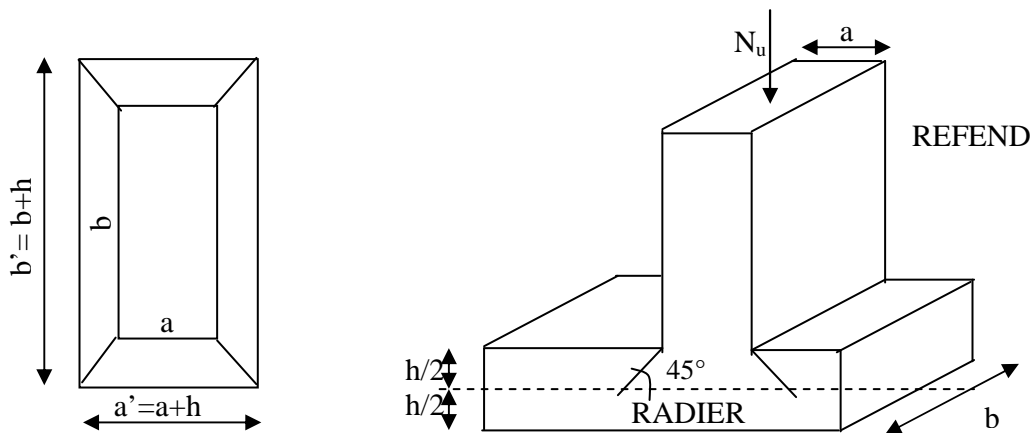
Périmètre utile des voiles et des poteaux
